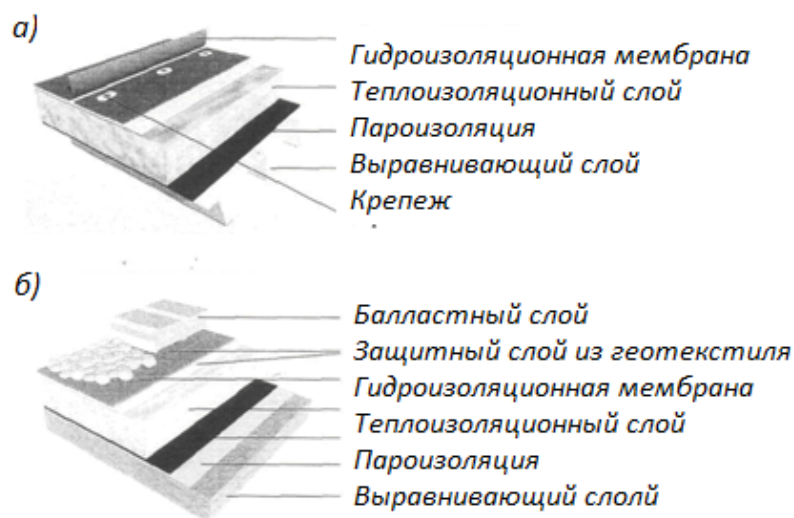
Крепление полимерных гидроизоляционных мембран с механическим (а) или балластным (б) креплением
